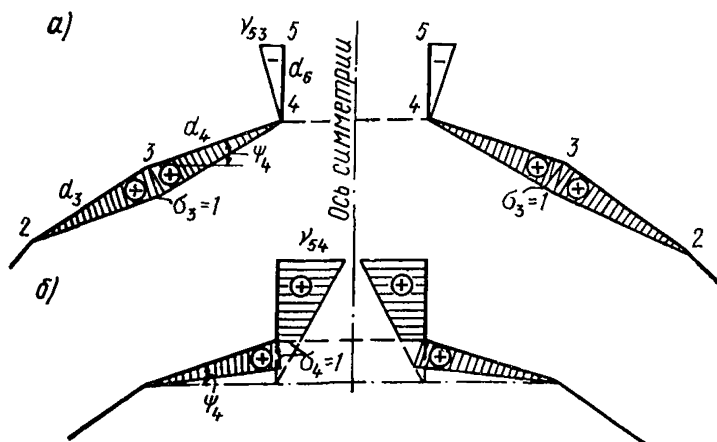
К расчету складок с фонарным проемом и подфонарными балками
